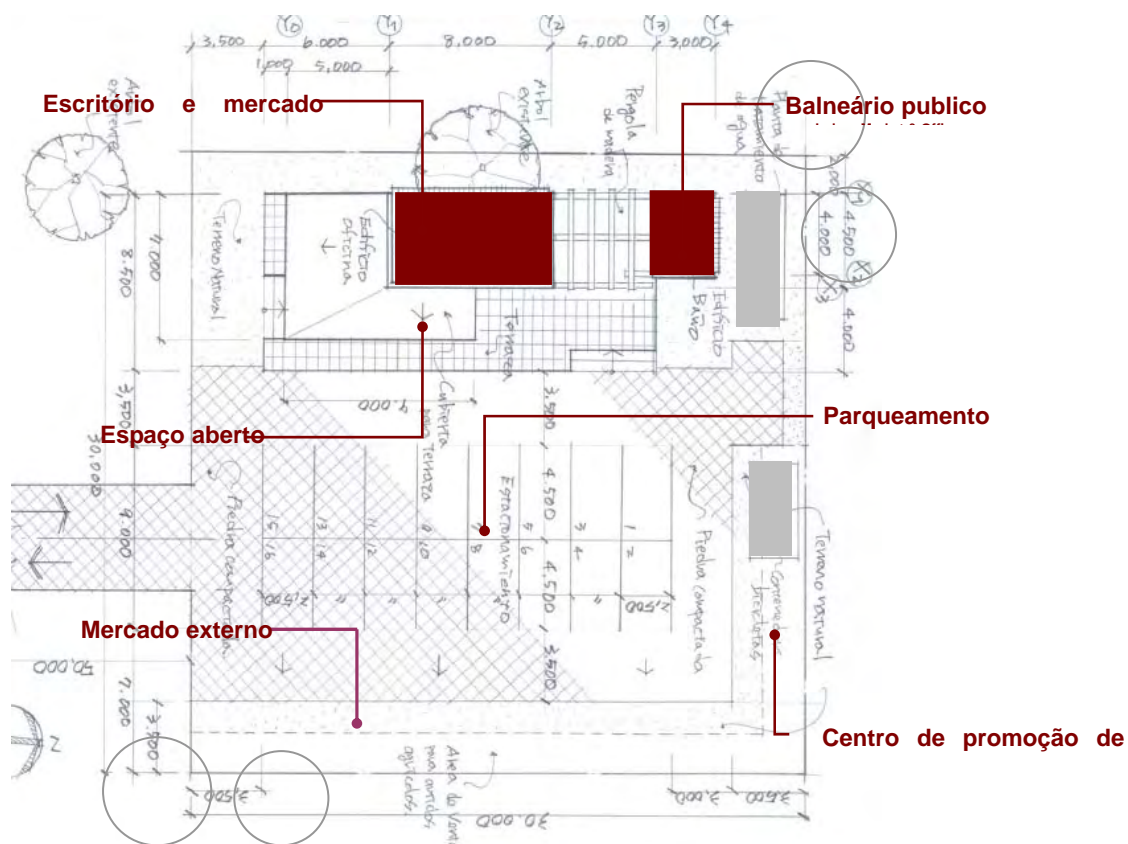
Planta das Instalações (elaborada pela equipa de Estudo)
